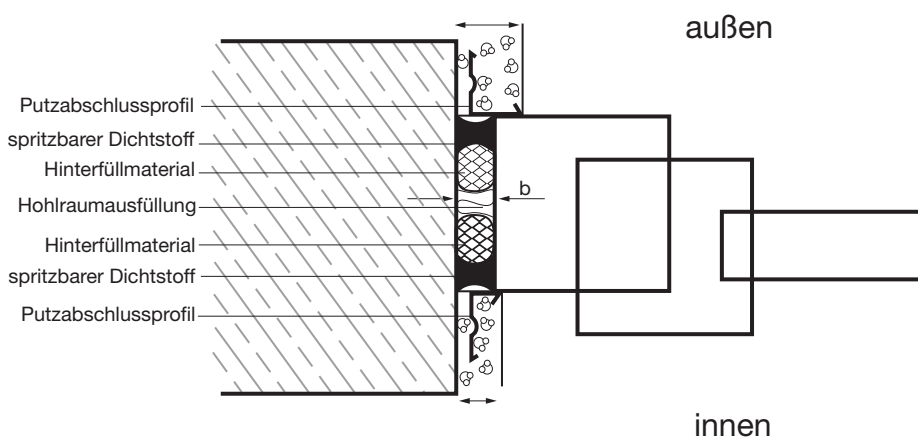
Fachgerechte Fugenabdichtung vor dem Verputzen des Baukörpers.
